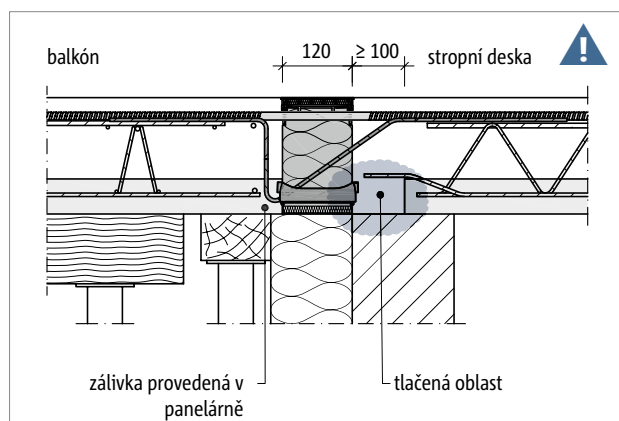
Schöck Isokorb® CXT typ KL: Prefabrikovaný balkón, jehož spodní hrana je snižena vůči stropní desce uložené na předem vybetonované železobetonové stěně
